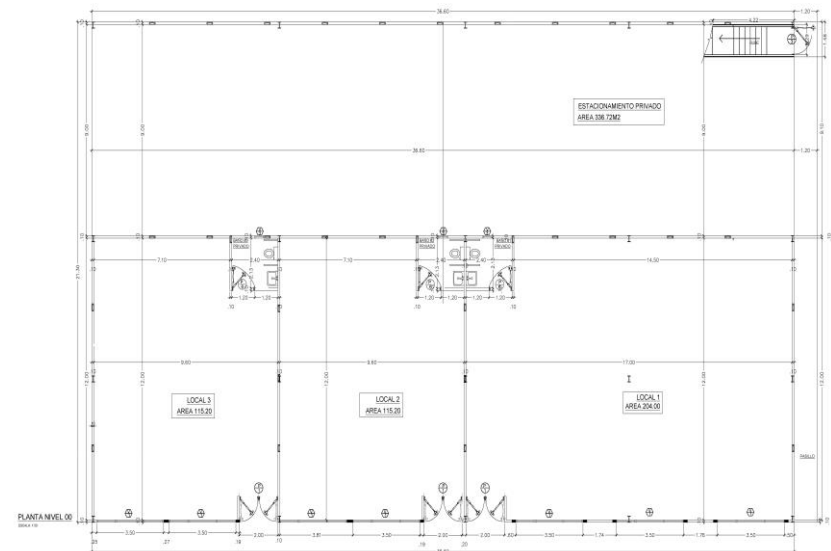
Diseño de la planta baja del Proyecto (Nivel 000)
